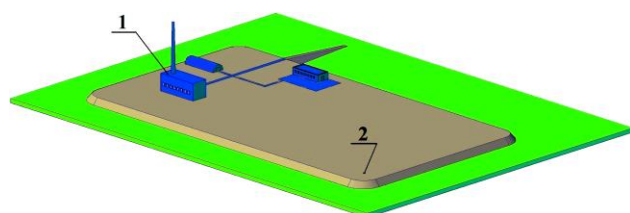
Схема формирования и использования отвала как строительной площадки:
